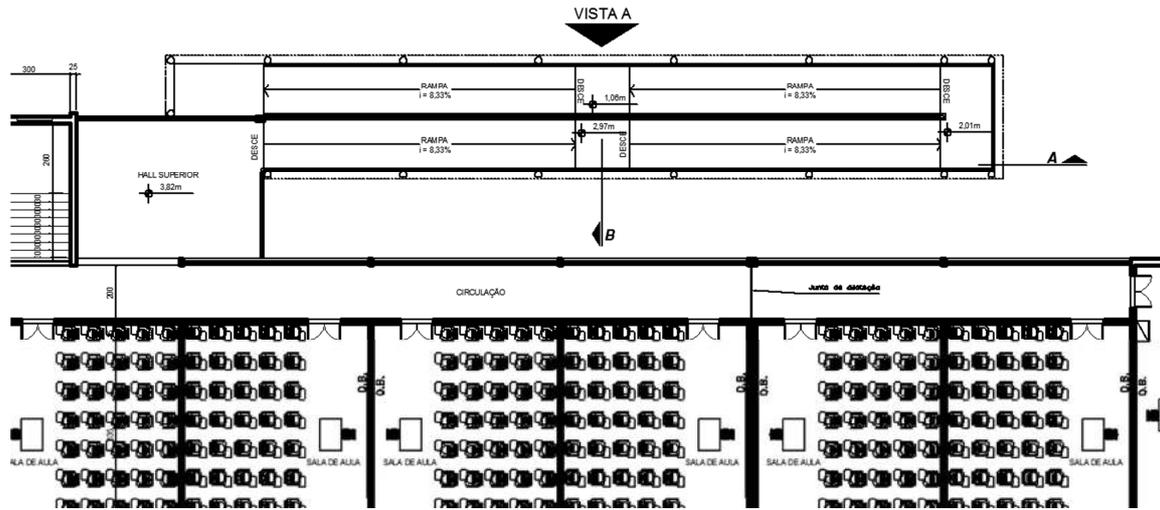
PAVIMENTO SUPERIOR - BLOCO PEDAGÓGICO – CAMPUS PLANALTINA
